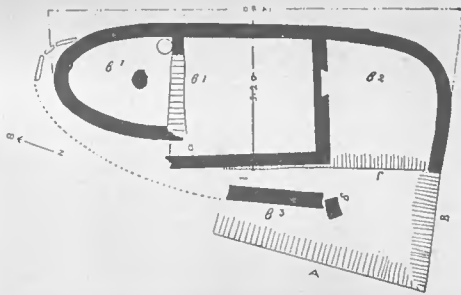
Grundriss einer Gebäudes der Frühzeit, Thermon. Nach Δελτίον, II, 1916, fig. 14.
